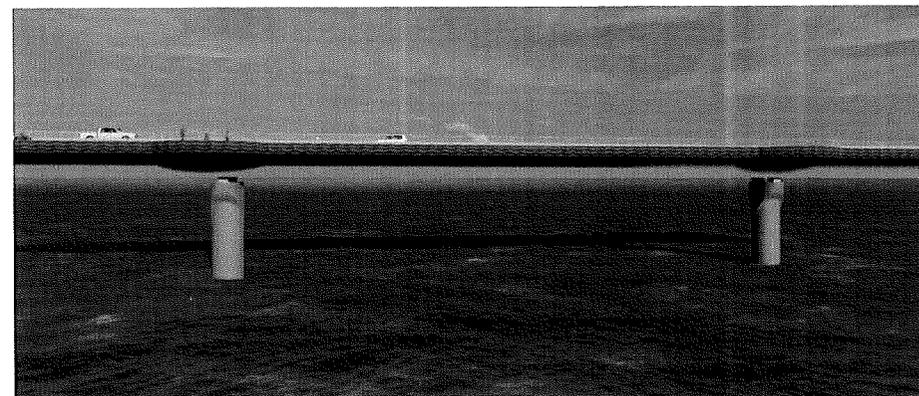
principe de perspective du nouveau pont (source : Lavigne & Chéron architectes)
